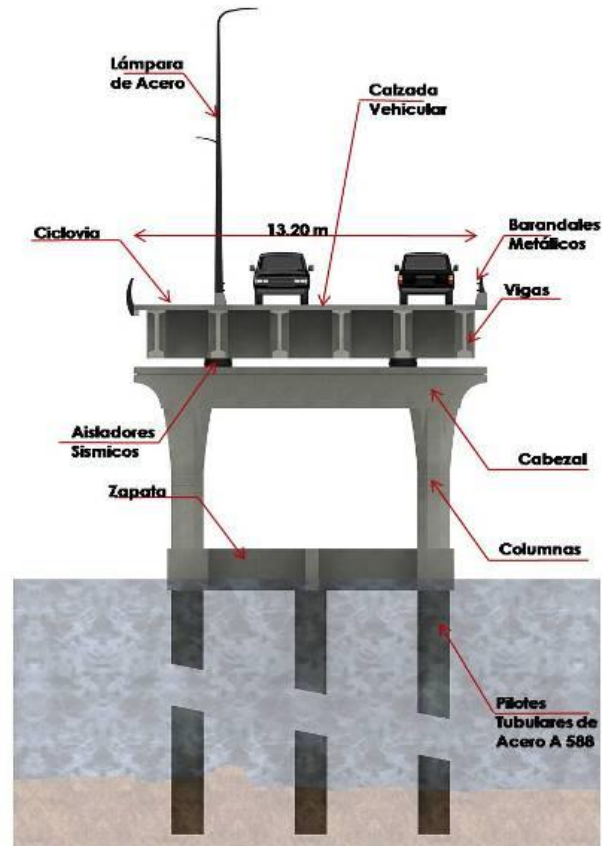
PERFIL DE LA ESTRUCTURA DEL PUENTE (1)
